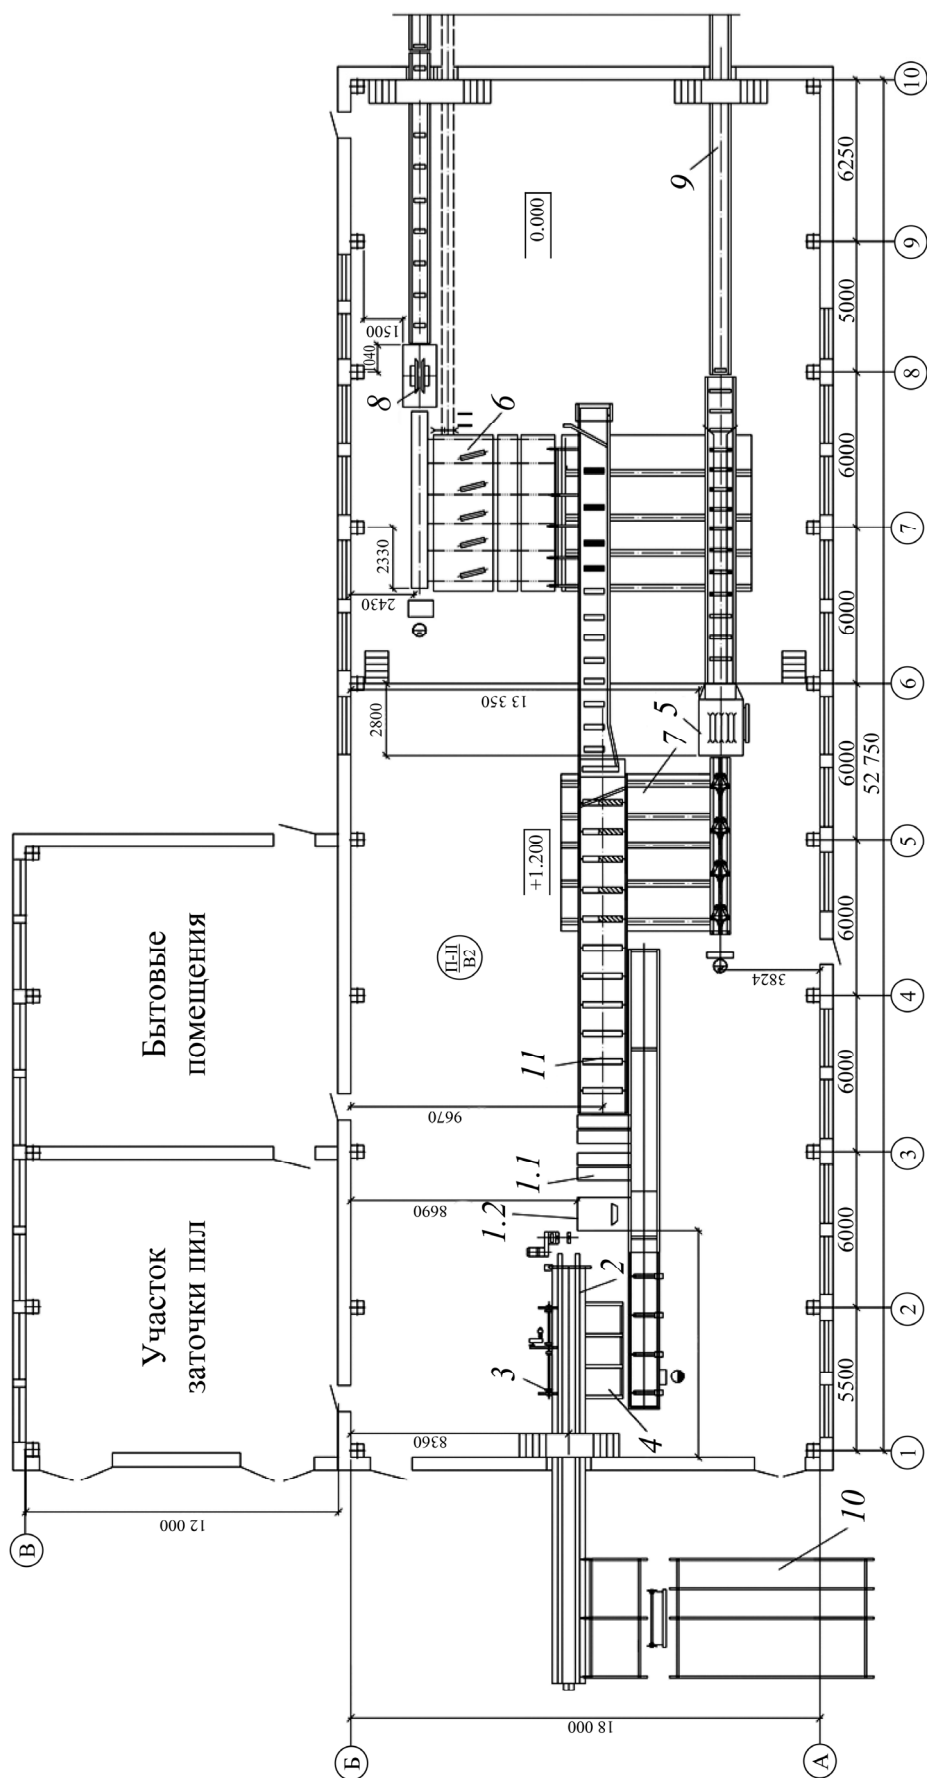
Схема лесопильного цеха на базе вертикального ленточного станка:
